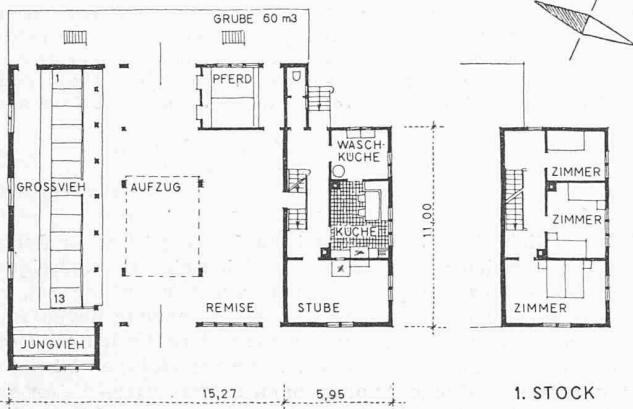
Siedlung Städlimad 1:400. Das Wohnhaus wurde als Ständerbau ausgeführt und erhielt einen Schindelschirm; der Stall ist gemauert. Diese traditionelle Form des Wohnhauses unter dem gleichen First wie die Scheune ergibt stattliche und klare Baukörper. Damit die Tenne frei durchfahren werden kann, muss sie quer zum First liegen, was einmal den Nachteil hat, dass der Fuderaufzug mit seiner grösseren Länge ebenfalls quer steht und deshalb weniger hoch in den Dachraum reicht; ferner ist das Optimum an Besonnung nicht zu erreichen wegen der entgegengesetzten Lage von Wohnung und Stall.
